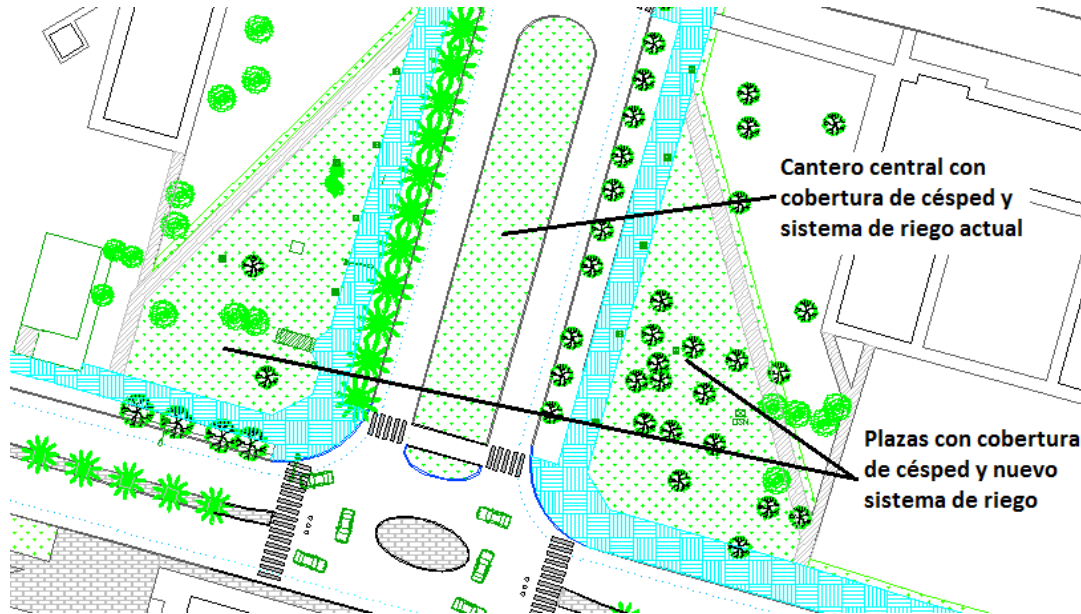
Cobertura de césped y sistema de riego propuestos para la zona Central
